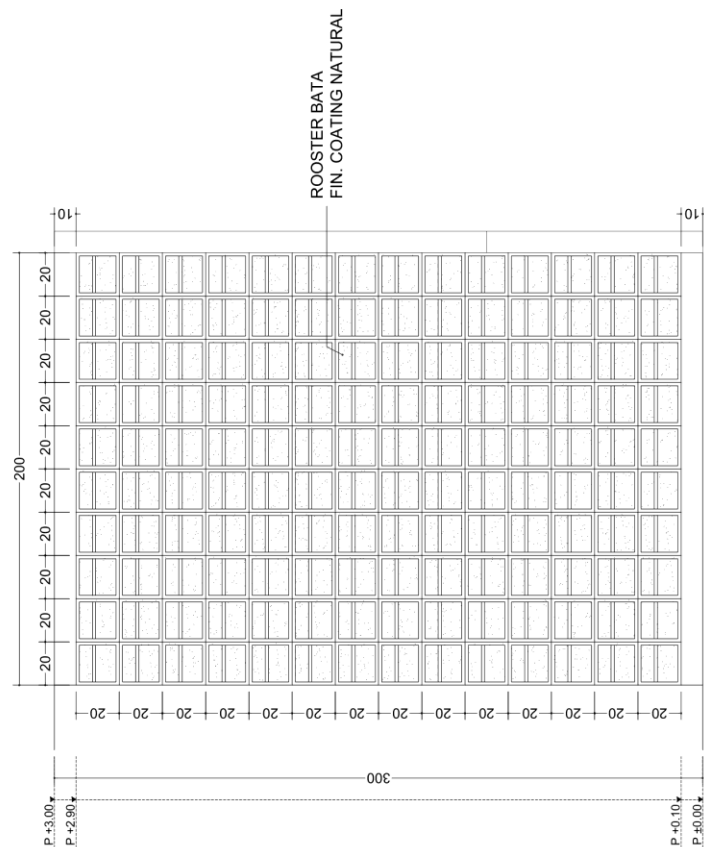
DETAIL ROOSTER BATA DEPAN TERAS LT. 1
